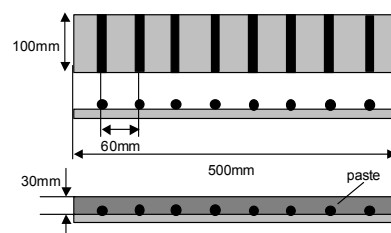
プラスチック収縮ひび割れ試験の供試体
